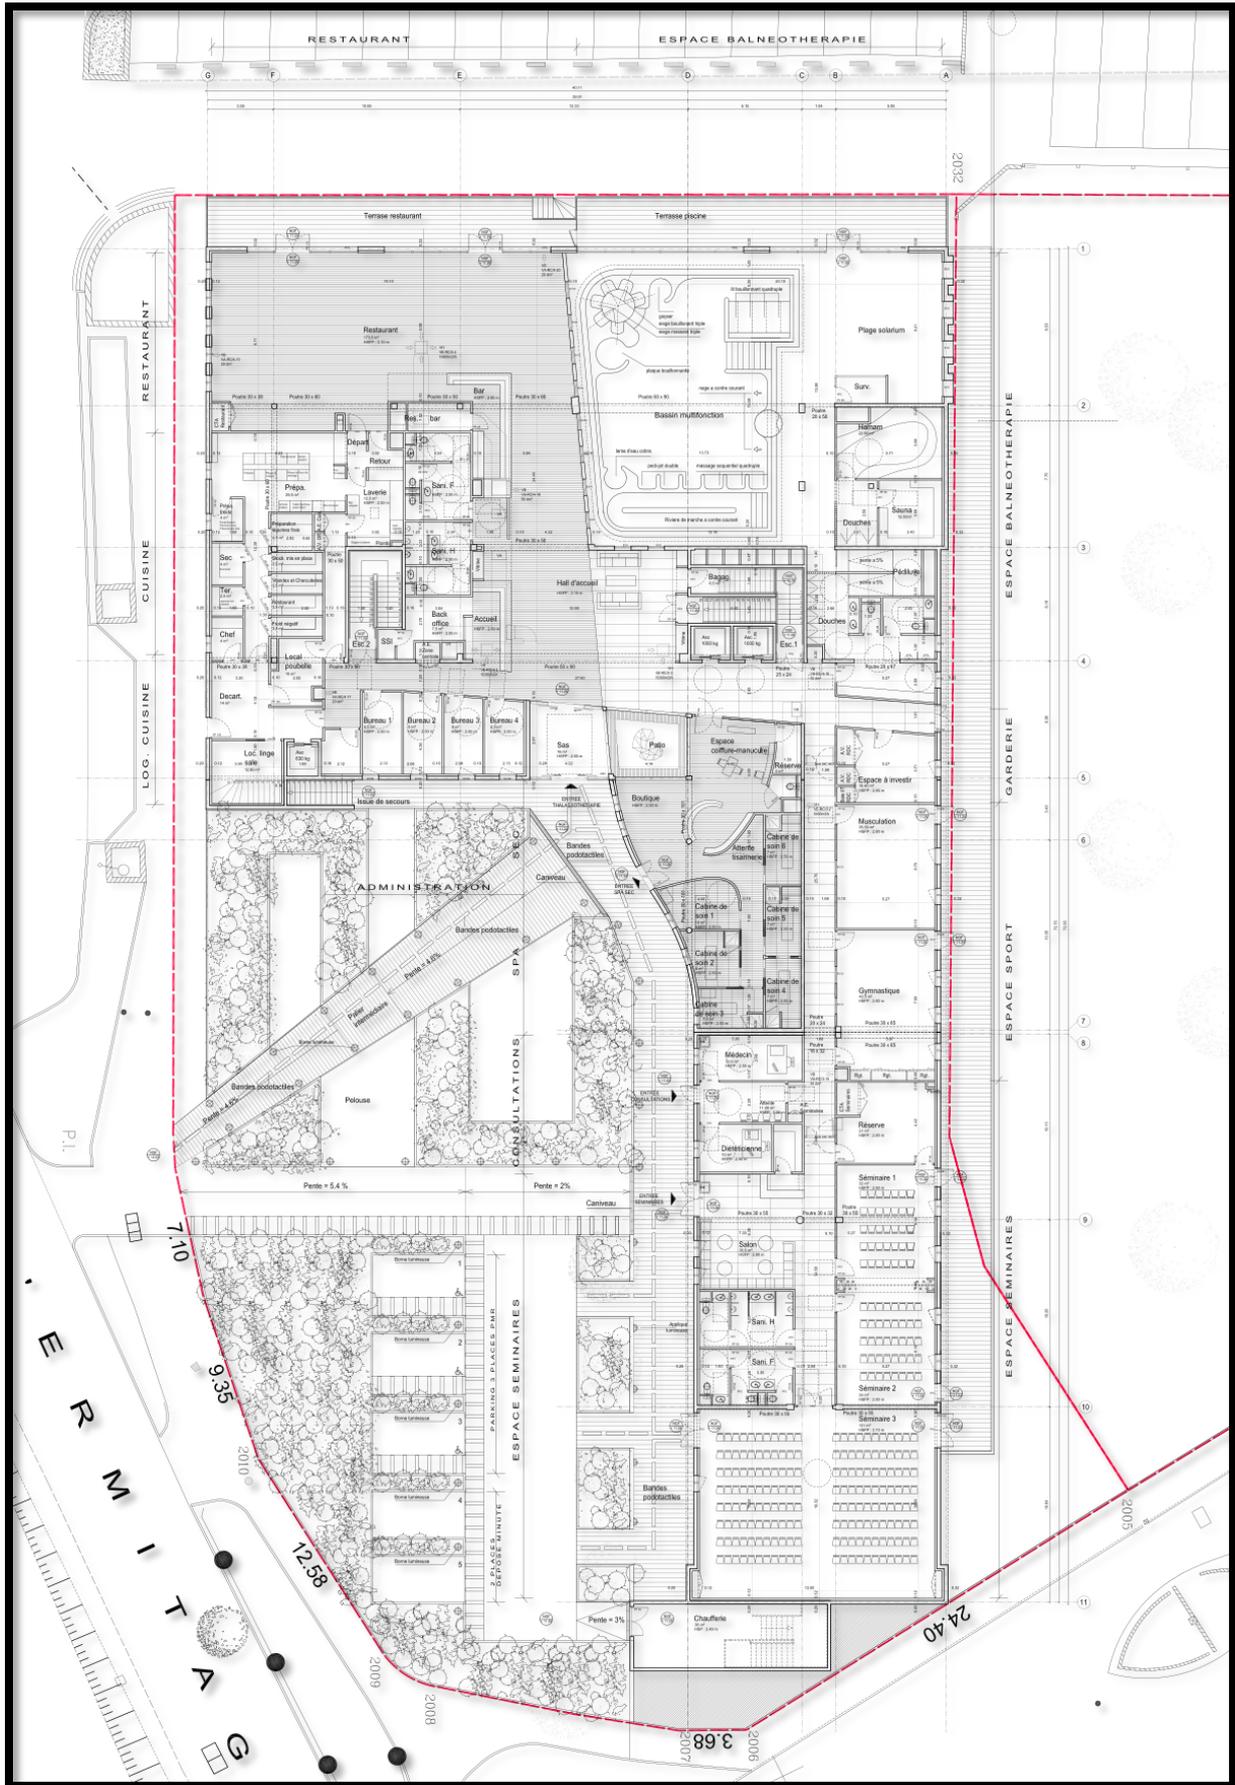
plan Du rez de chaussée du centre de thalassothérapie Donville-les-bains
